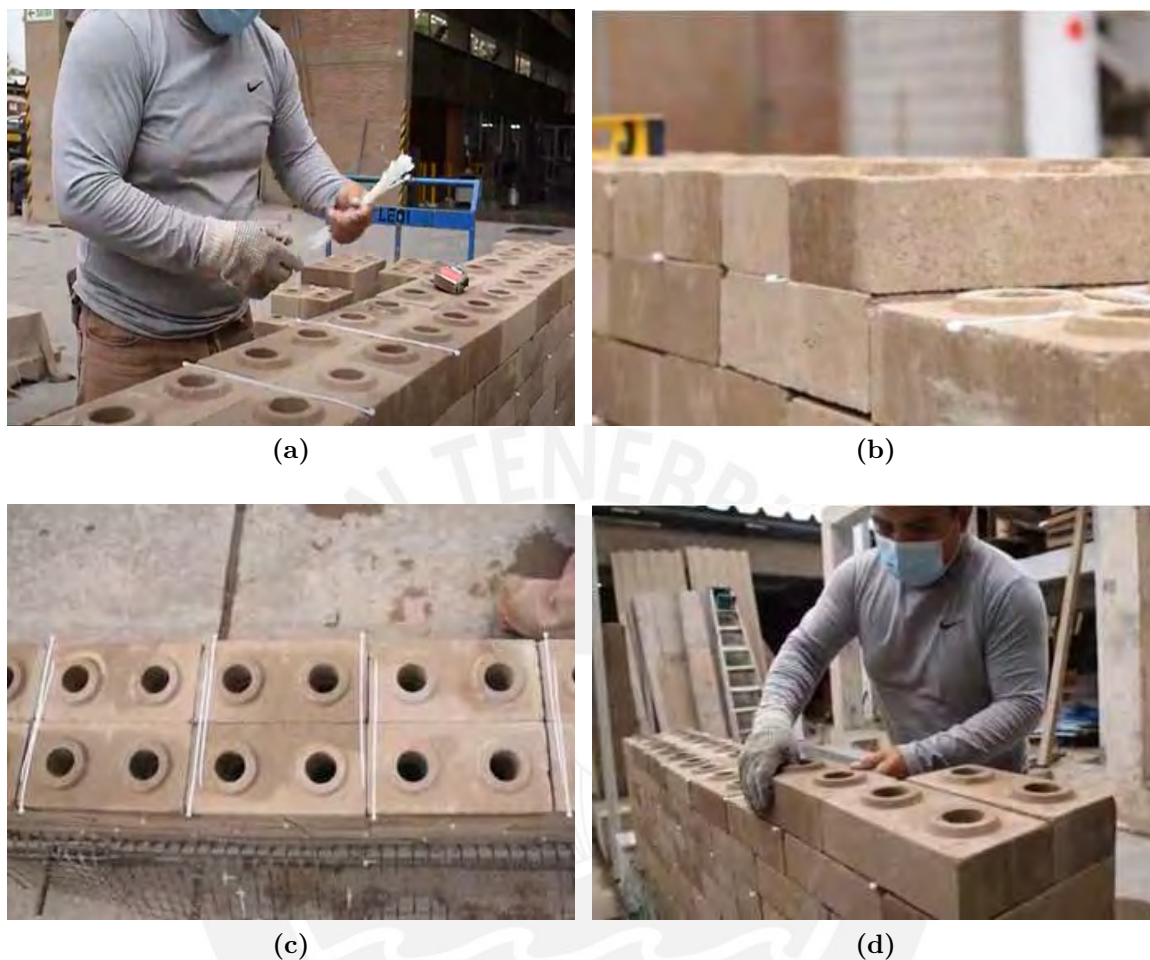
Proceso constructivo de los muros reforzados con geomallas.
